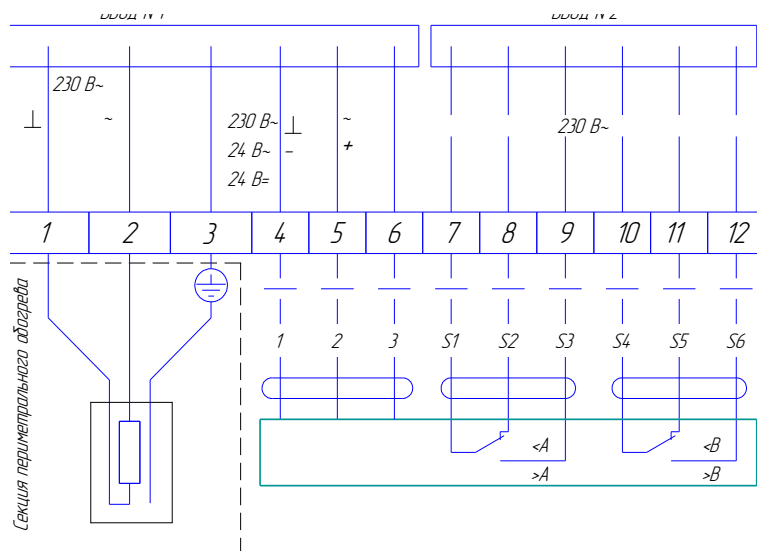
Схема для привода BLE230, BE230, BLE24, BE24 (для приводов без обогрева секции периметрального обогрева нет, позиций 1, 2 и 3 клеммной колодки нет)
